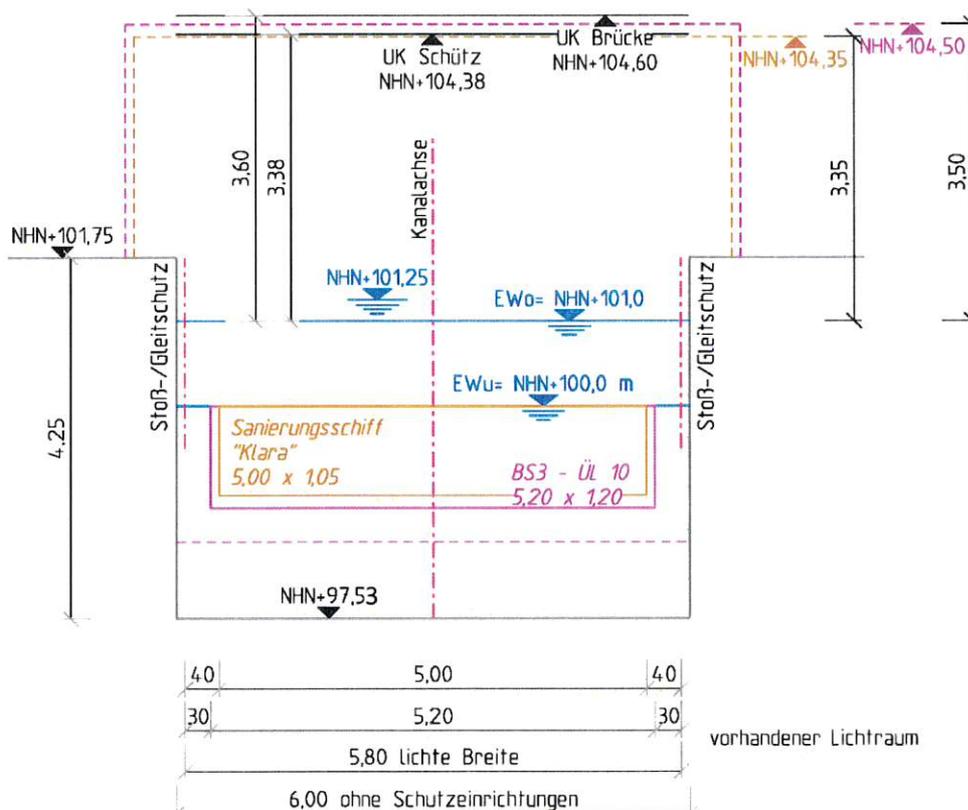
Rechteckprofil – Richtungsverkehr mit BS3 oder Sanierungsschiff „Klara“
